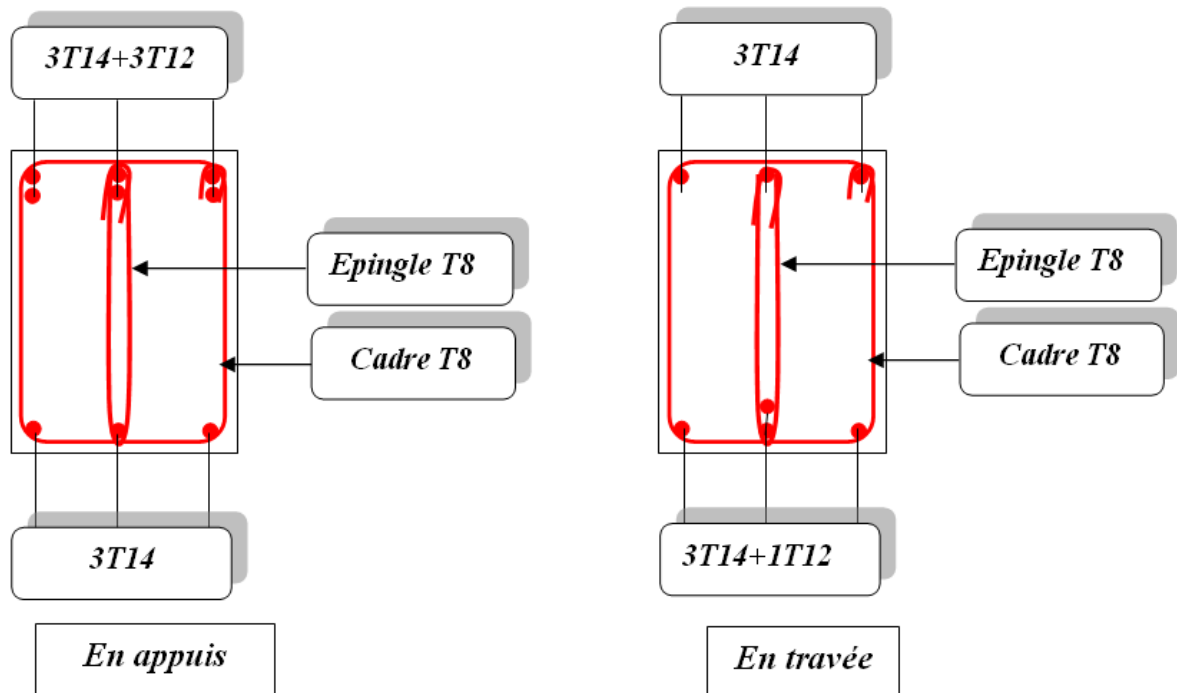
Schéma de ferrailage des poutres principales (30*40)
